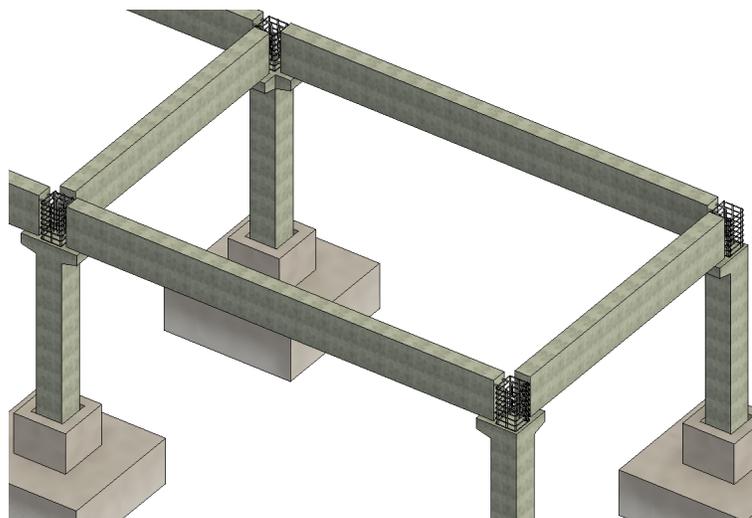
Sistema montado previo a conexión mediante hormigón en sitio. Fuente: Elaboración propia.
